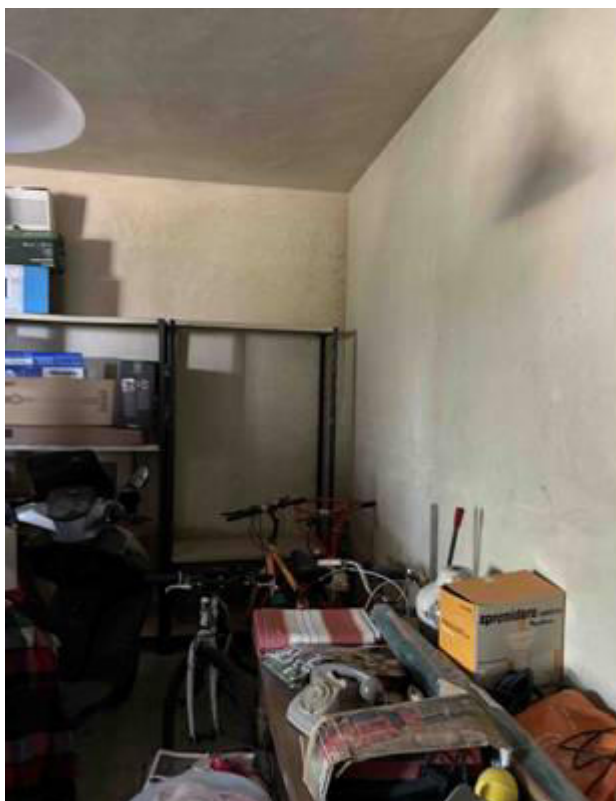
Foto scattata in un altro locale adibito a deposito ed accessibile dal portico. Le pareti sono rifinite con intonaco civile e rifinite con tonachina.
